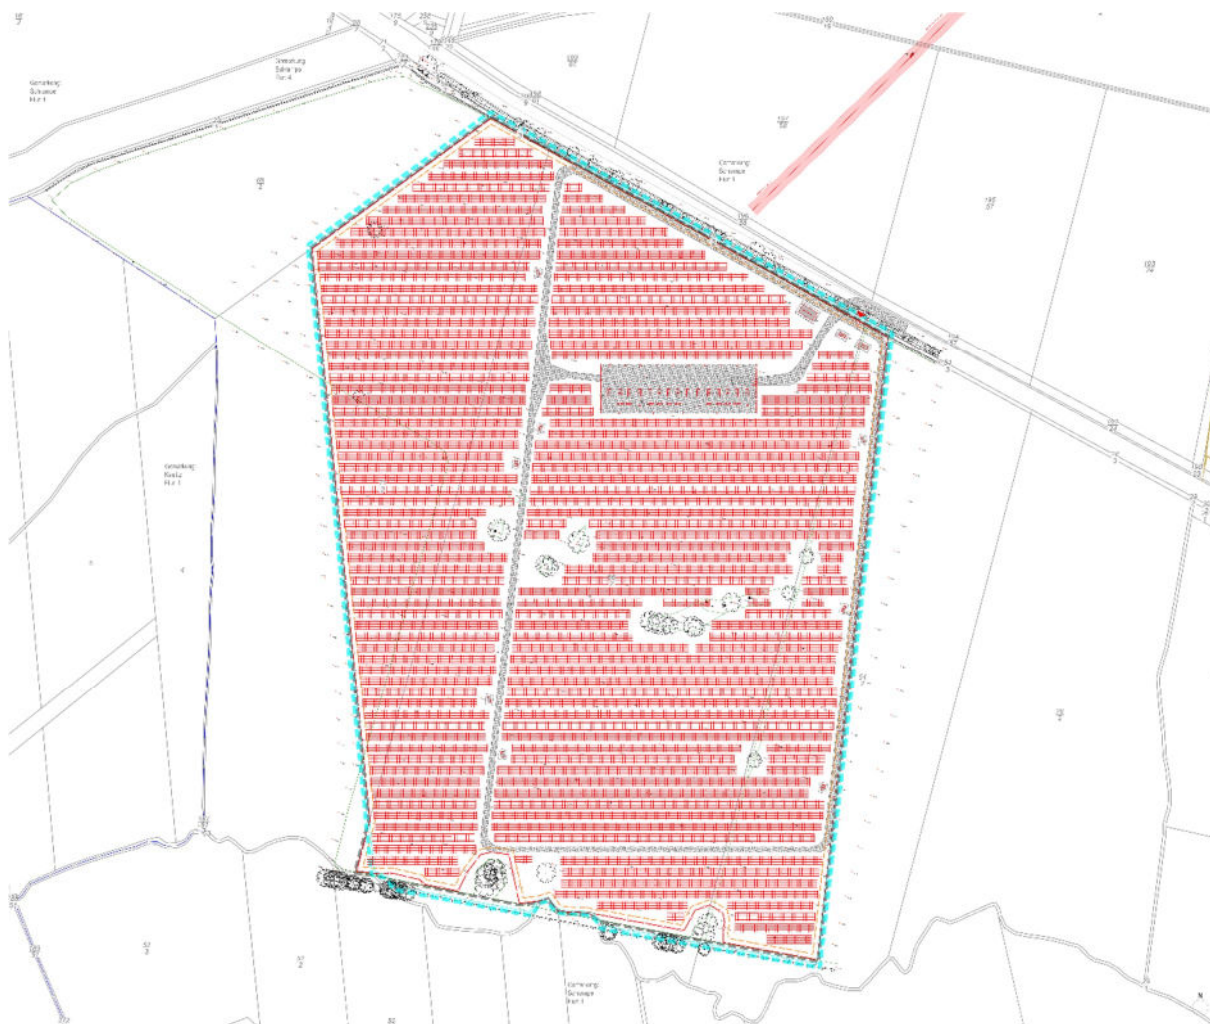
Layout des Solarparks Schrampe, ohne Maßstab; der Plan ist unverbindlich, es gelten die Festsetzungen des B-Plans (Quelle: klm Architekten Leipzig GmbH)
